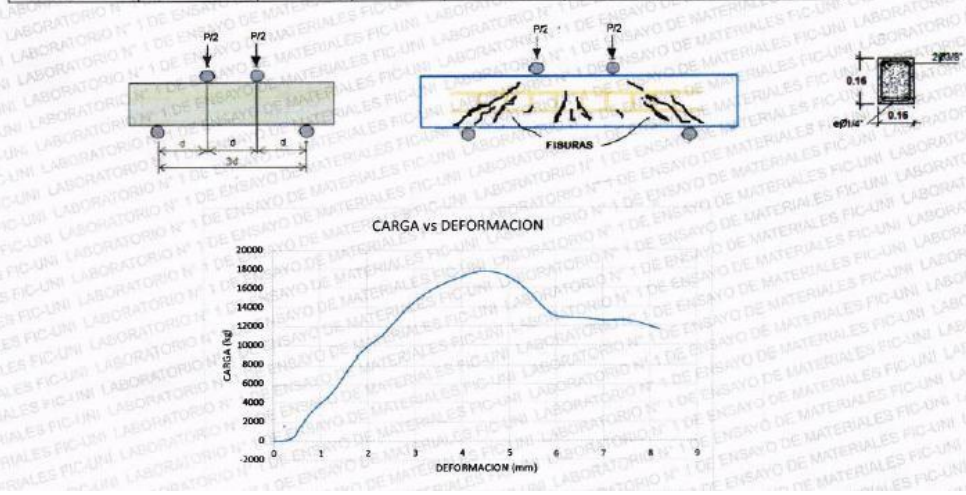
Carga máxima en flexión para viga 5 de concreto armado.
